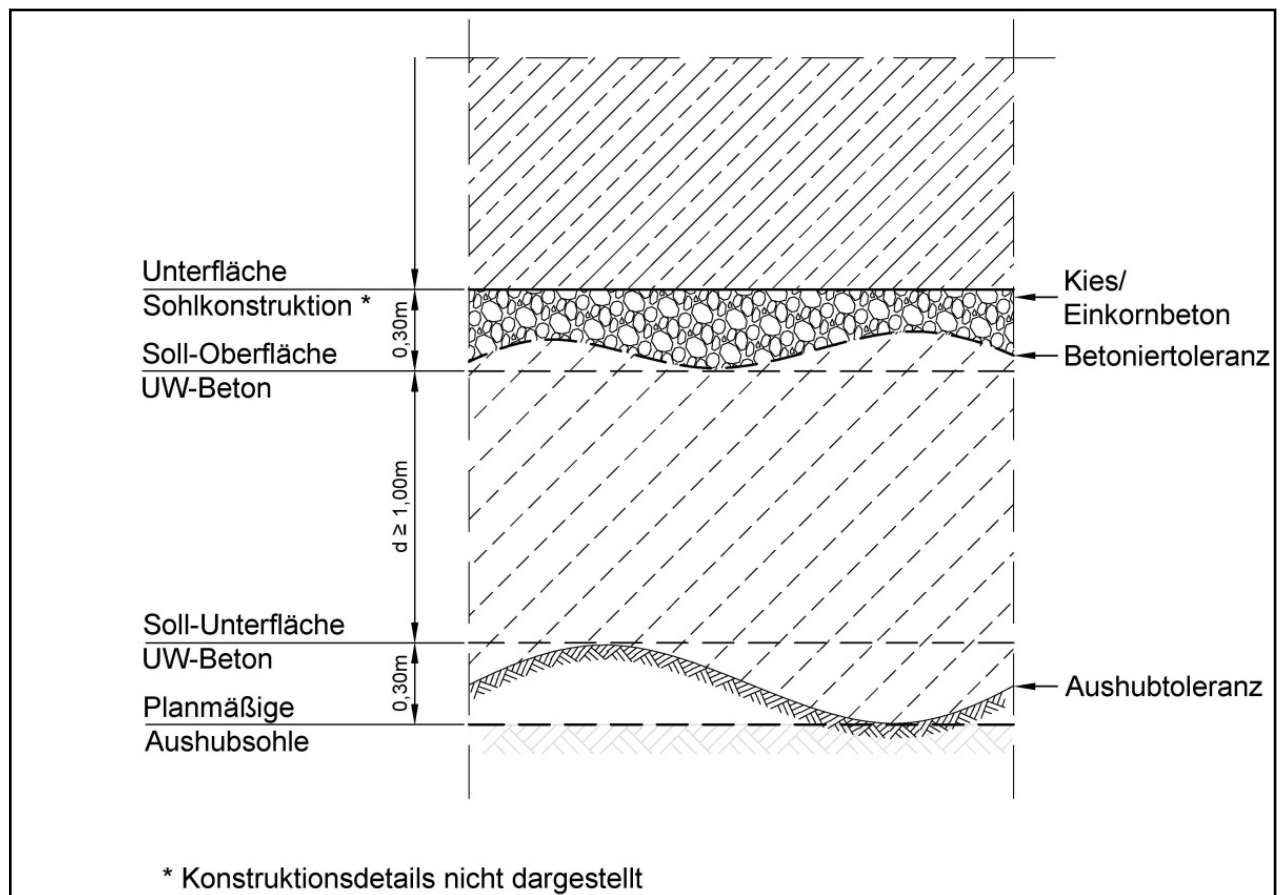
Darstellung der Ausführungssituation für eine Unterwasserbetonsohle
